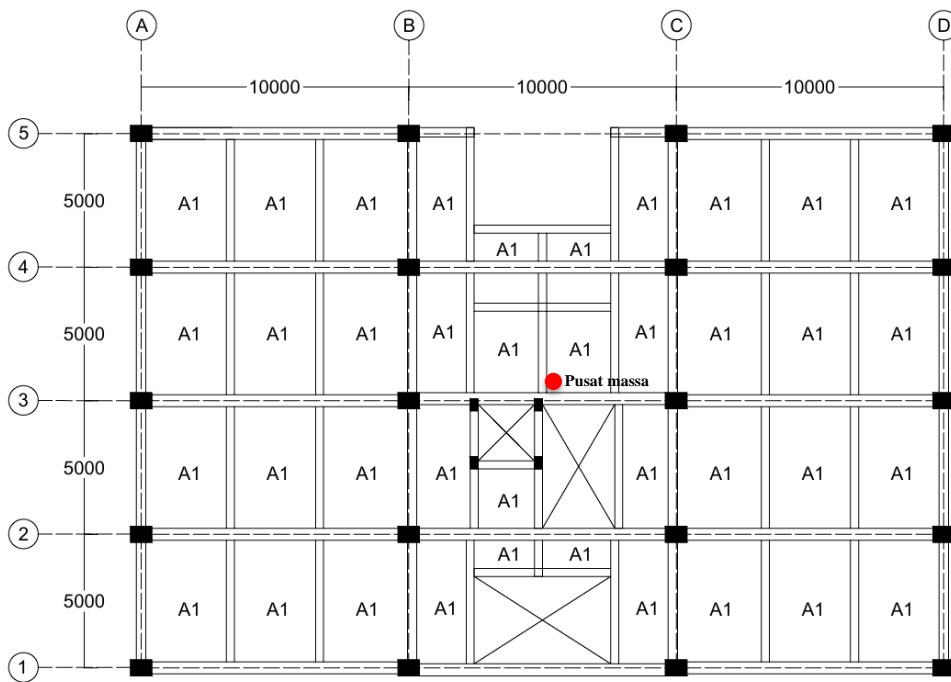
5 Kodifikasi Balok Model 1 Lantai 1 - 3
